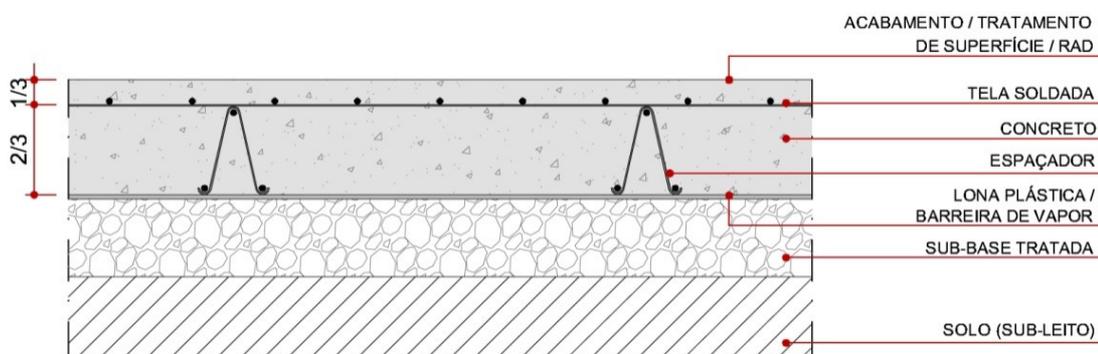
Pavimento de concreto com armadura distribuída continuamente
